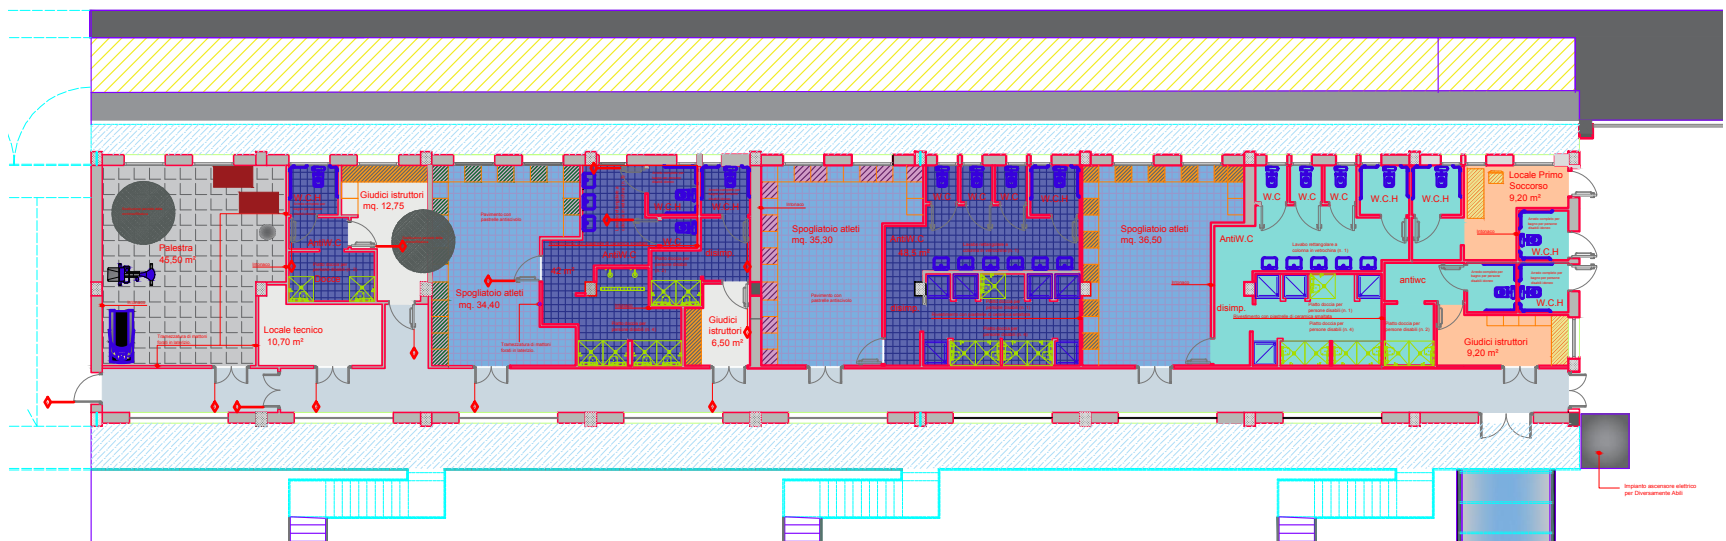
Pianta di Progetto Palestra e Spogliatoi
